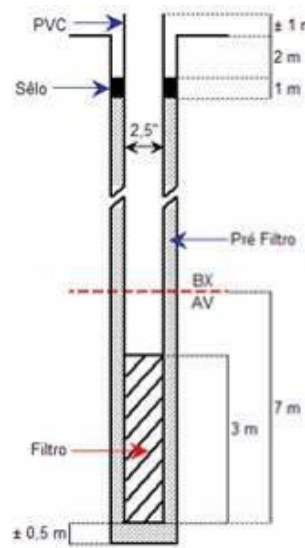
Perfil construtivo esquemático dos piezômetros rasos em áreas com lavra.
